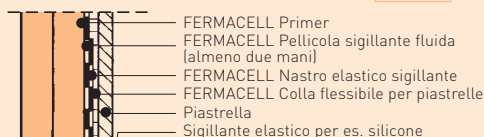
Formazione dell'angolo parete in area soggetta a presenza d'acqua
